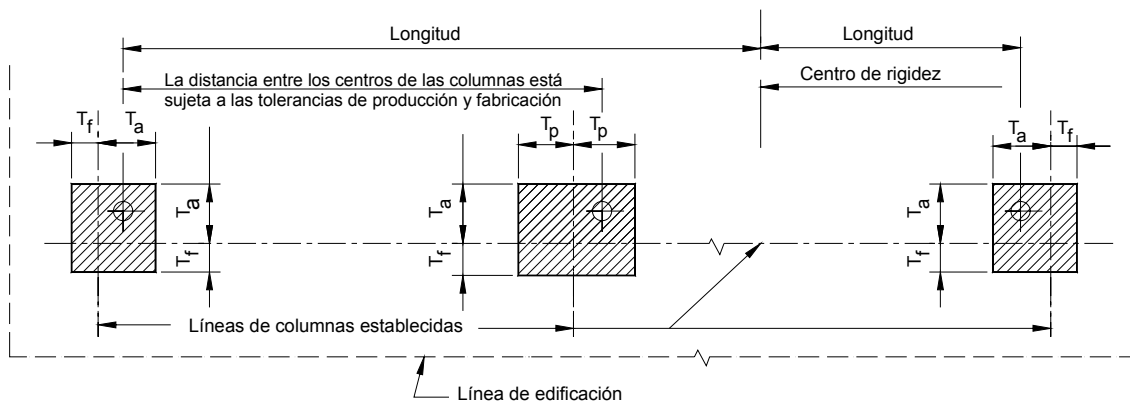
Tolerancias en planta para la ubicación de las columnas
